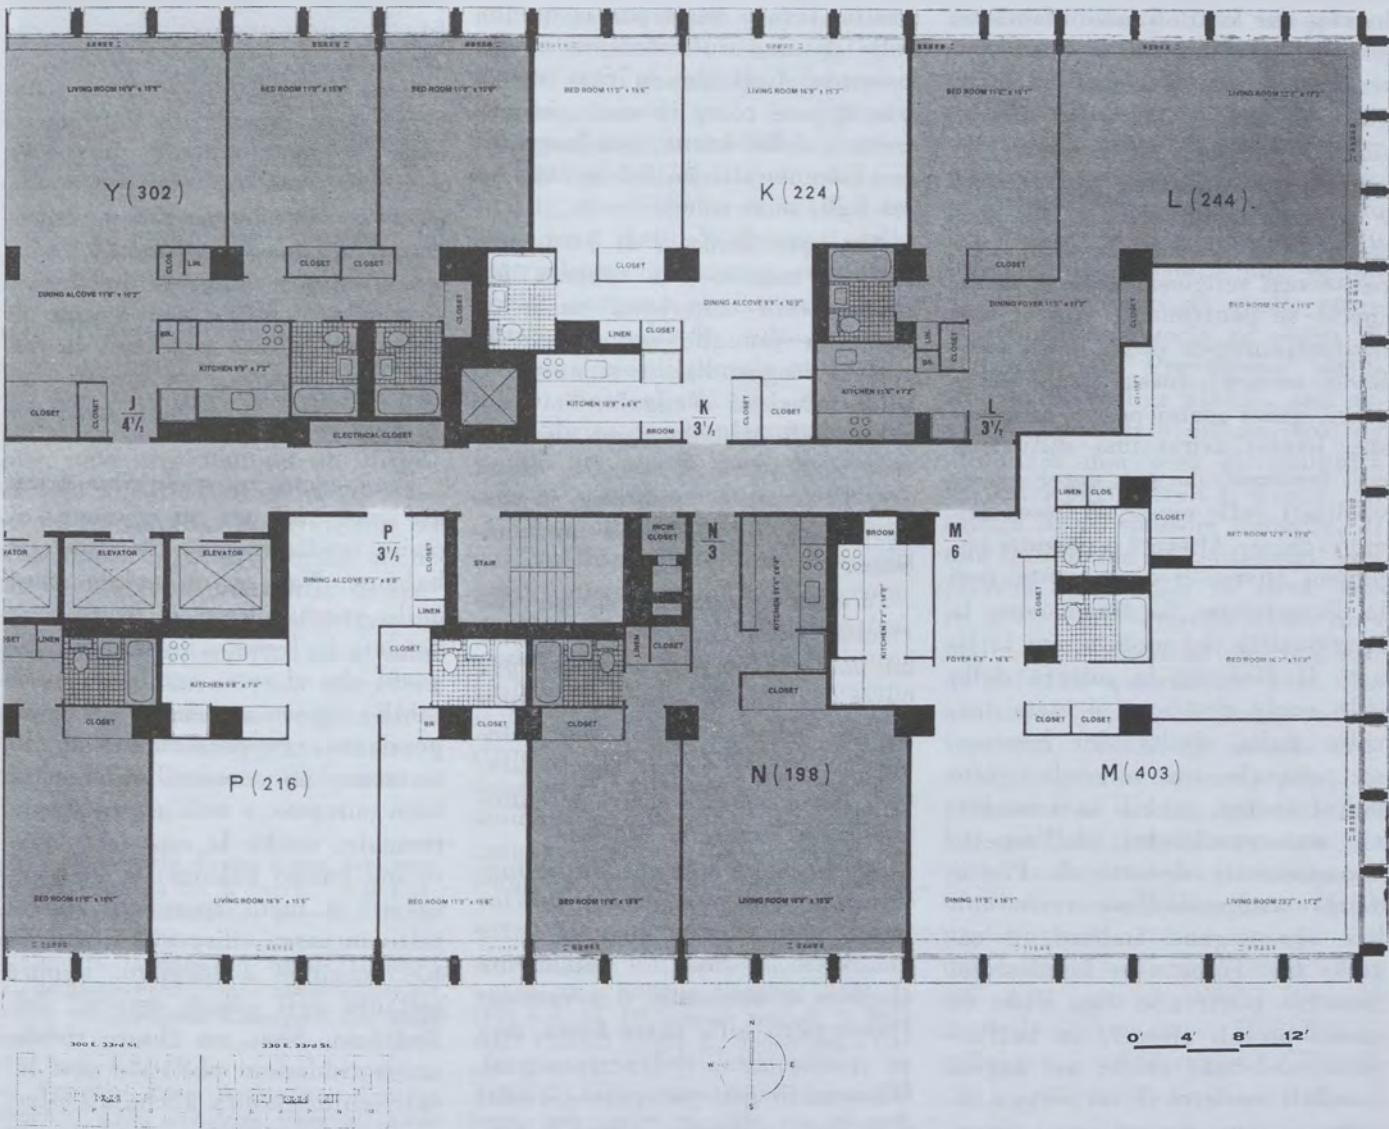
Planimetria generale (in basso, con indicate le lettere corrispondenti ai vari tipi di alloggio) e Pianta di $\frac{1}{4}$ del monoblocco (con riportate le lettere corrispondenti alla planimetria e a fianco, tra parentesi, l'ammontare dell'affitto mensile in dollari).
